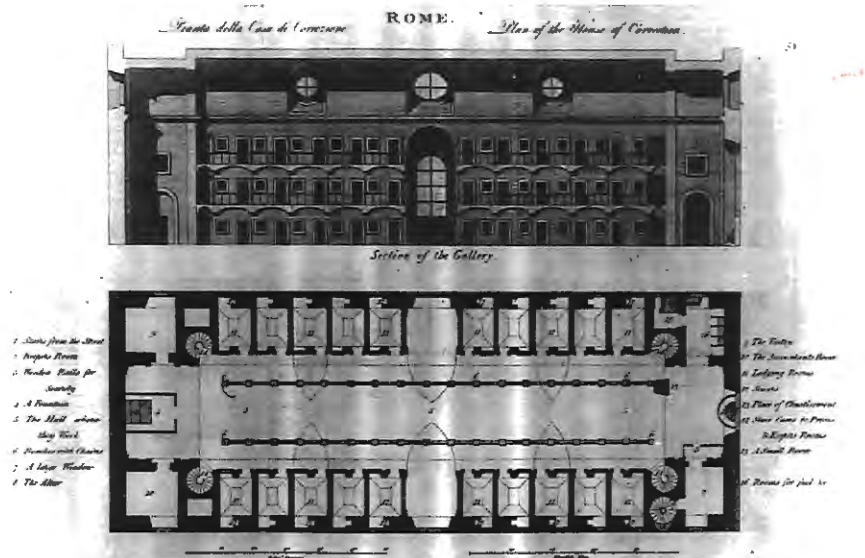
a 8: elevação, croqui, planta e corte da Casa de Correção San Michele, Roma, 1703-04. Fonte: *The fabrication of virtue: english prison architecture, 1750-1840*, p. 61-63.
